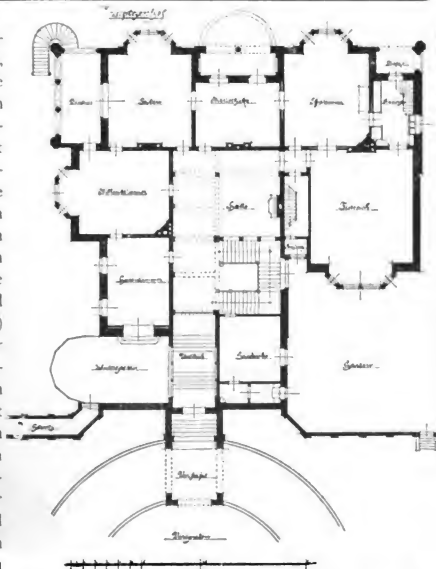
und 441. Wohnhaus Wätjen, Osterreich. Heinr. Müller. Fassade und Grundriß. 1858.
